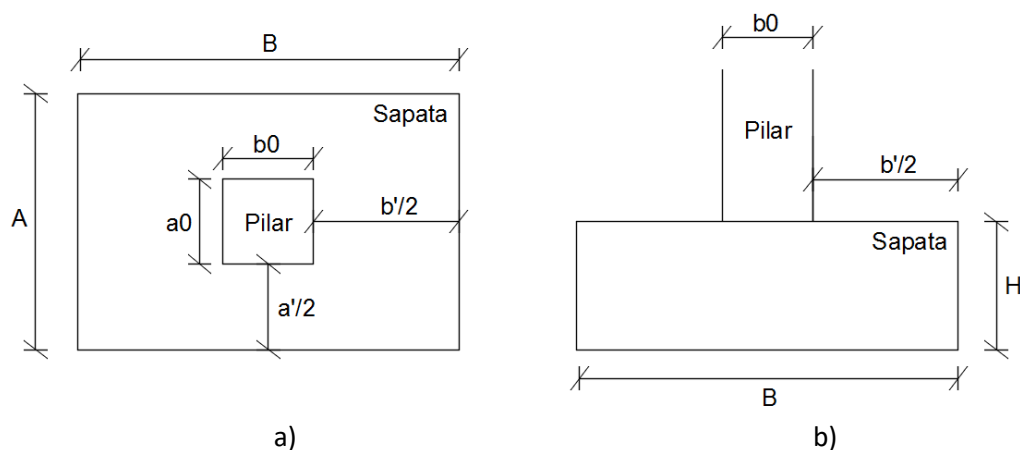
Sapatas: a) Vista em planta; b) Vista em alçado.
